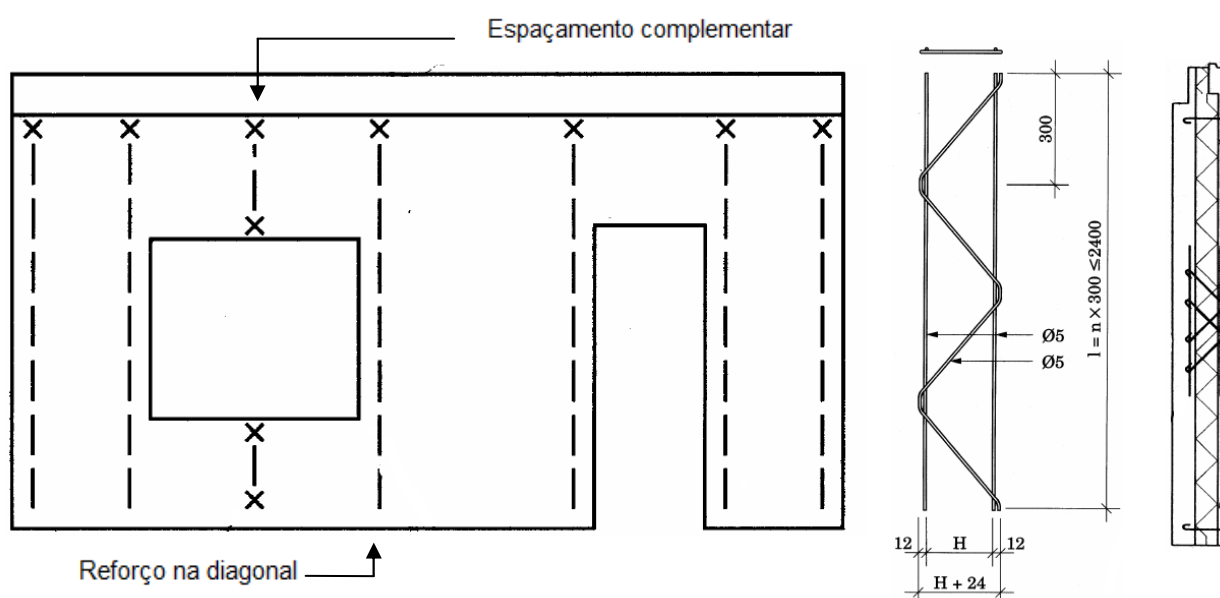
Ligação através de armaduras (Adaptado do FIB, 2011)
